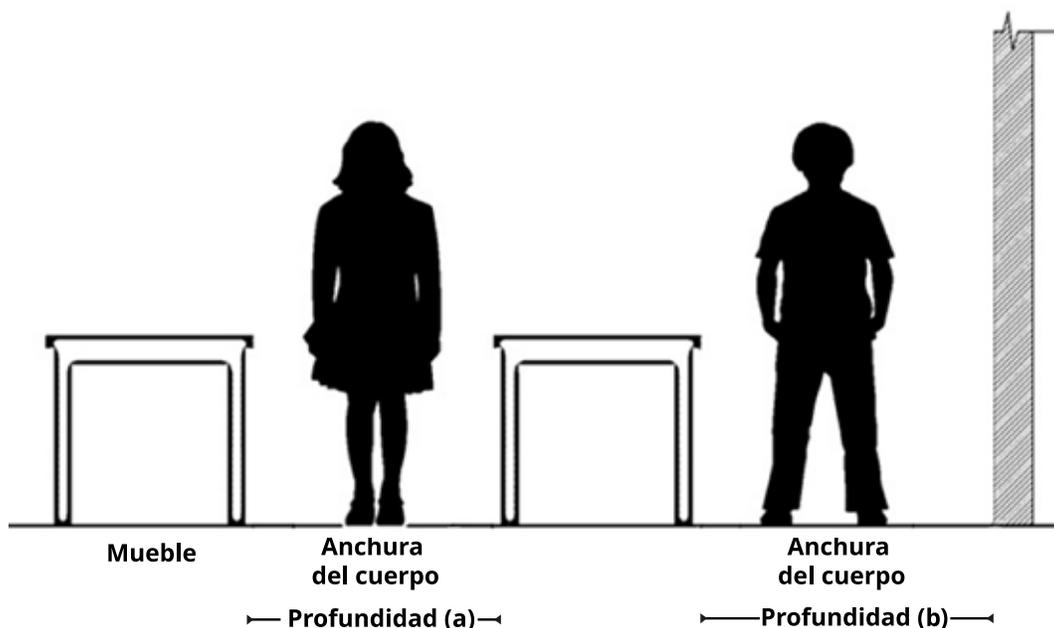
Separaciones mínimas entre muebles y entre mueble y muro
